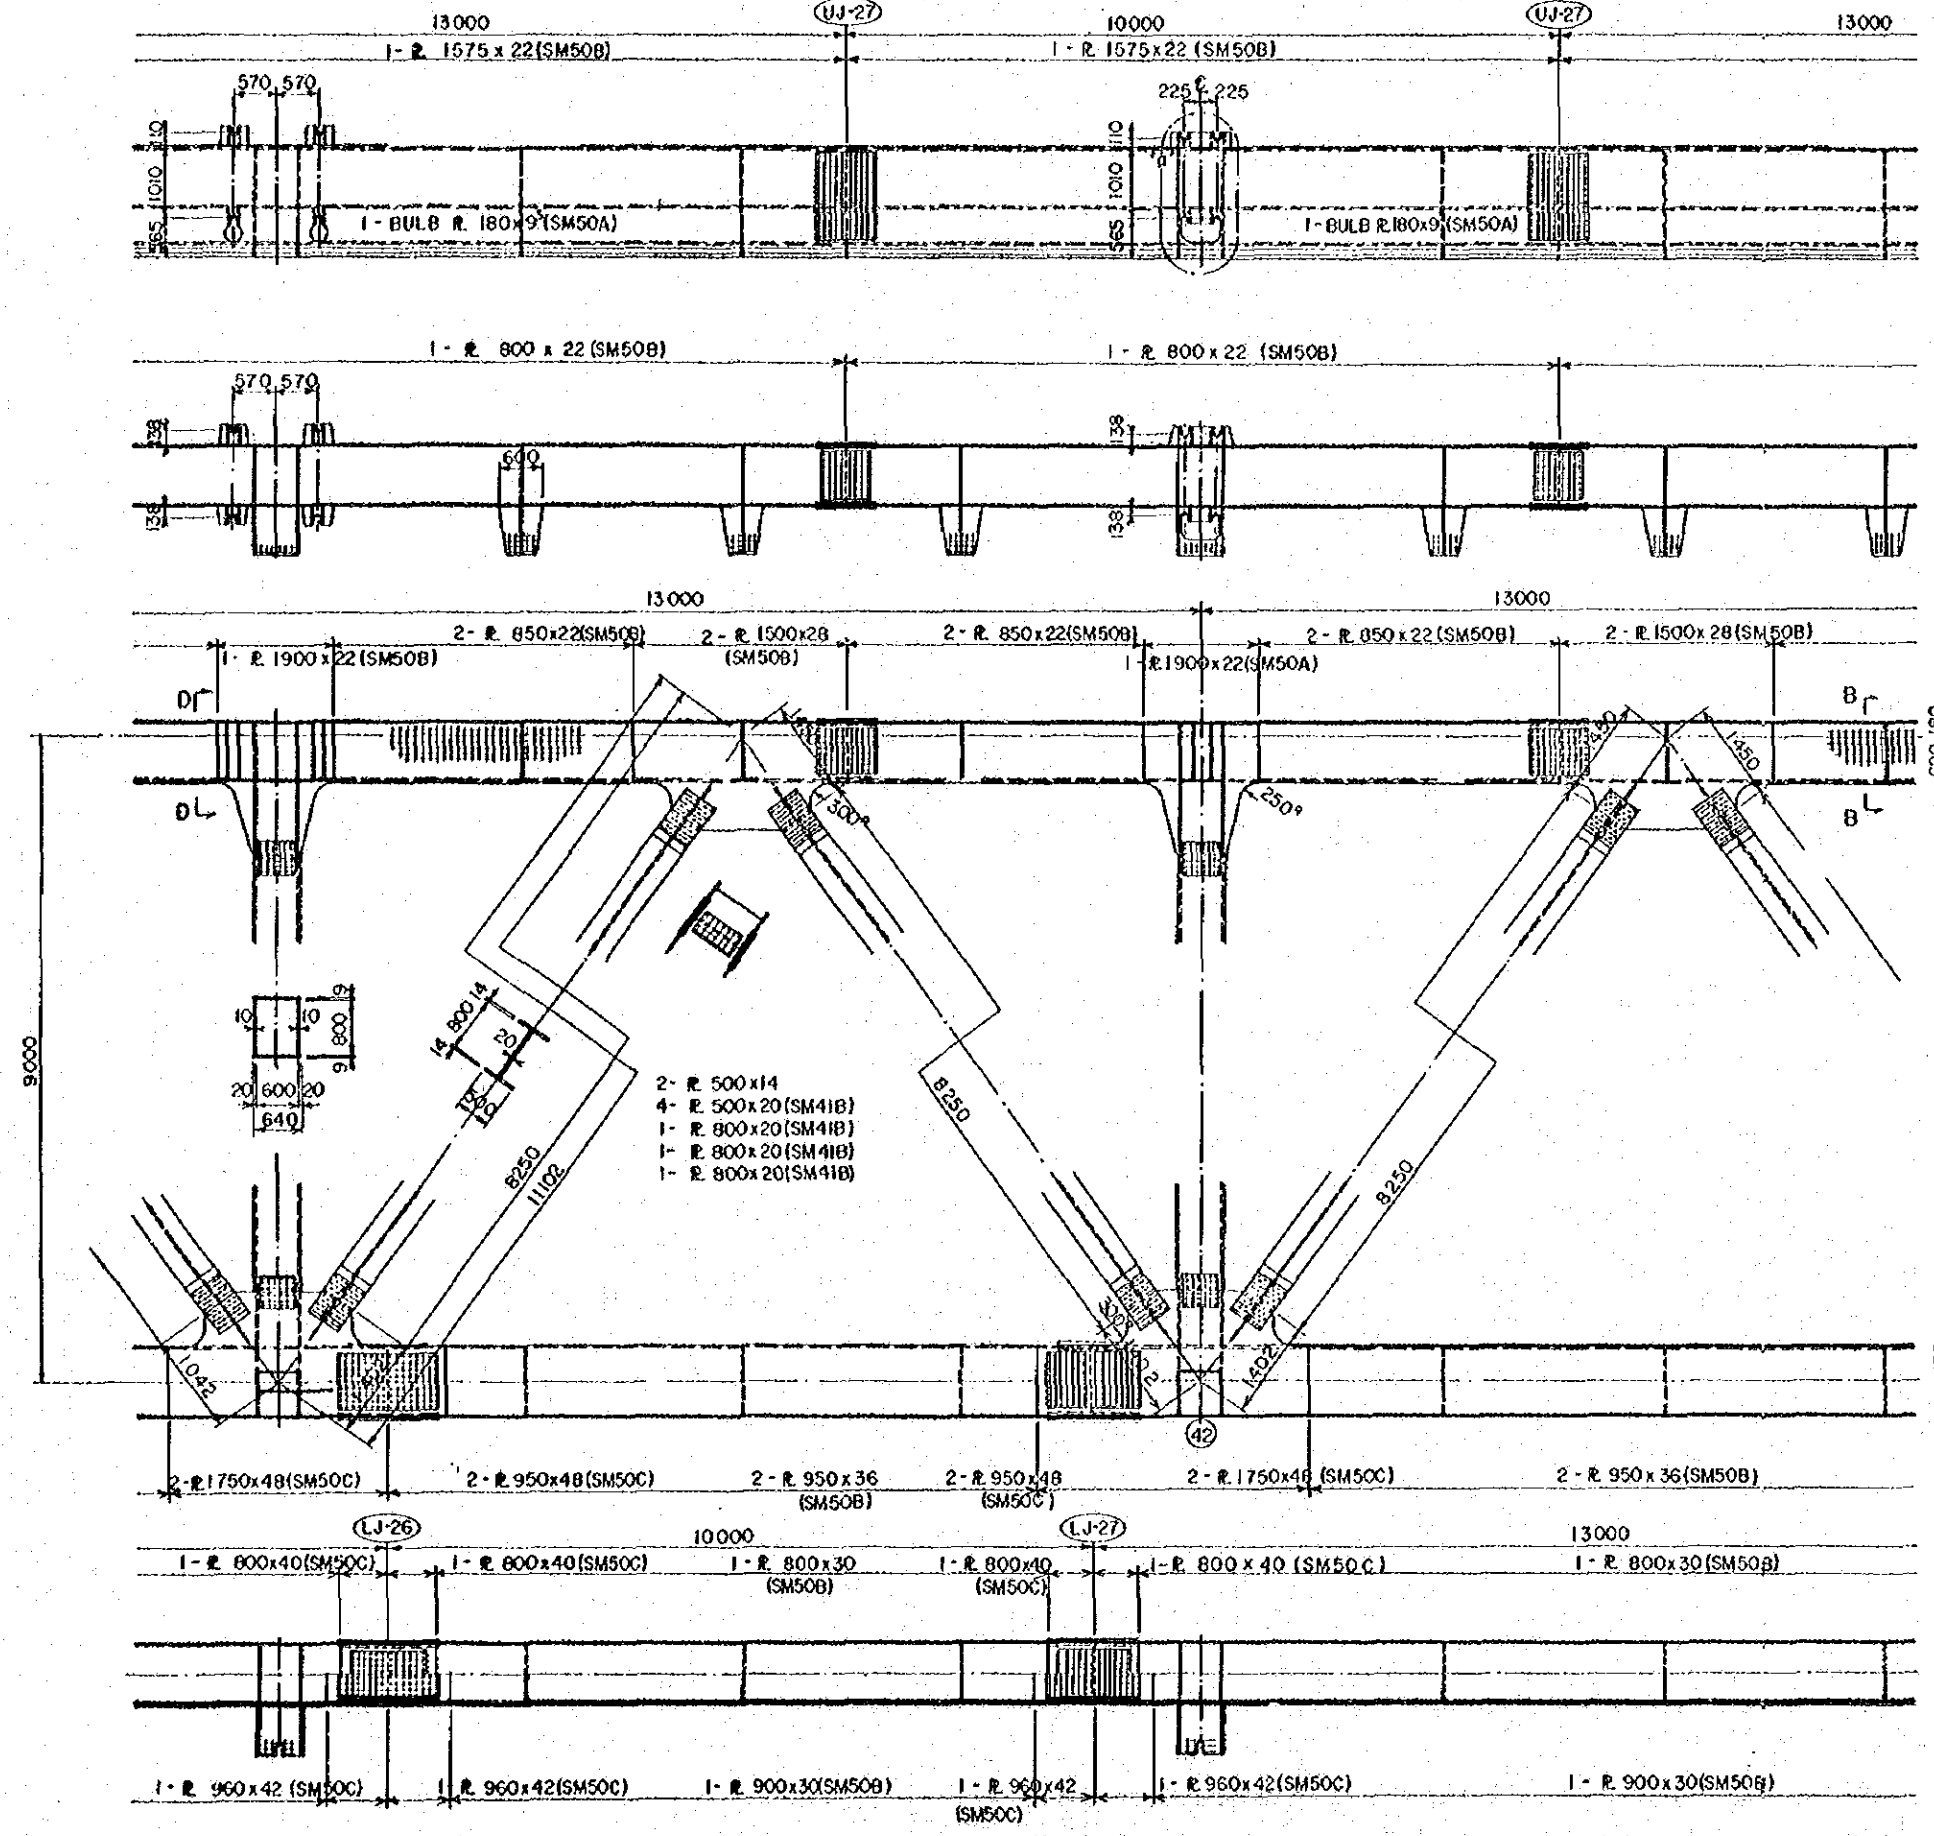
DETAILS DE POUTRE RAIDISSEUSE (2/3)
